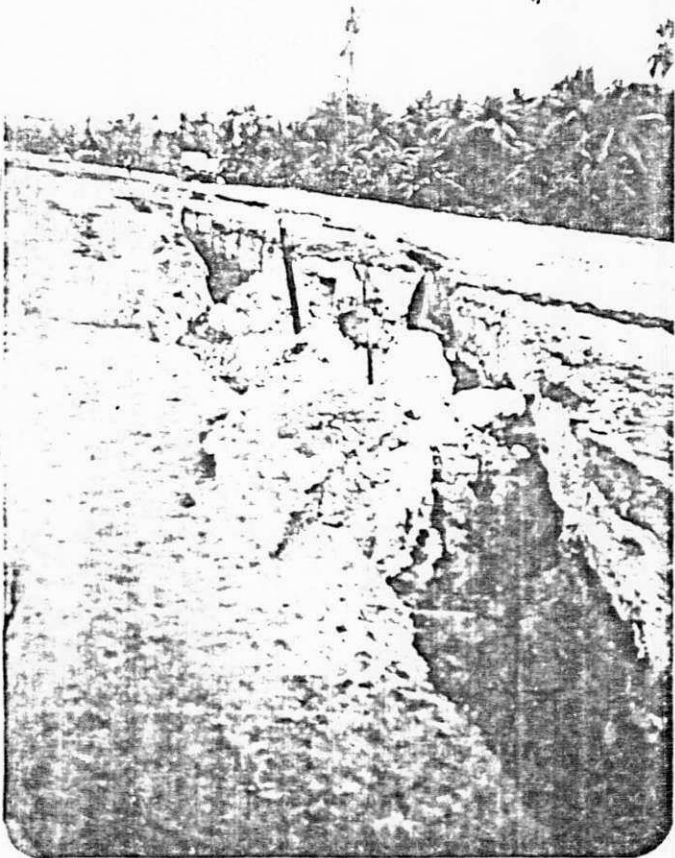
Vista do aterro desta Avenida, detalhando as ruturas ocorridas.
